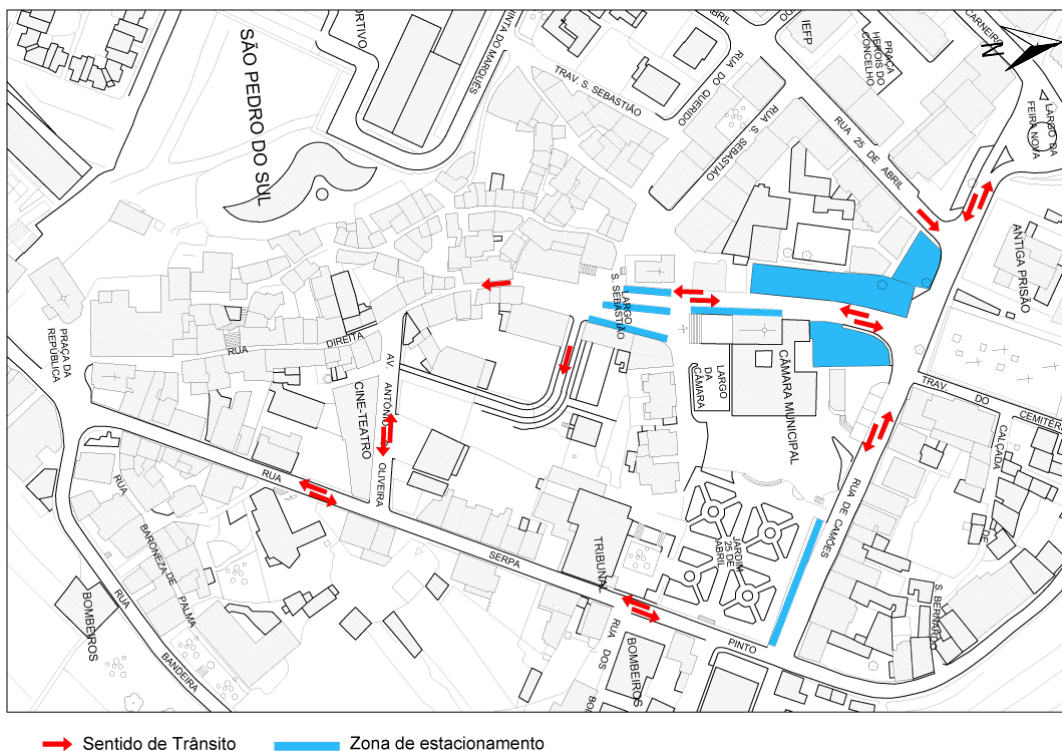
Planta com sentidos de trânsito antes da requalificação (s/esc.)
